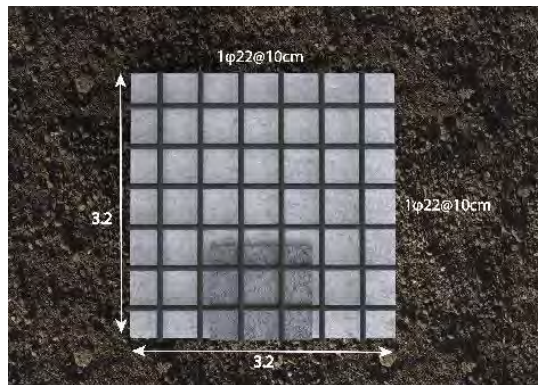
Diseños finales zapatas ejes C1 y C4
